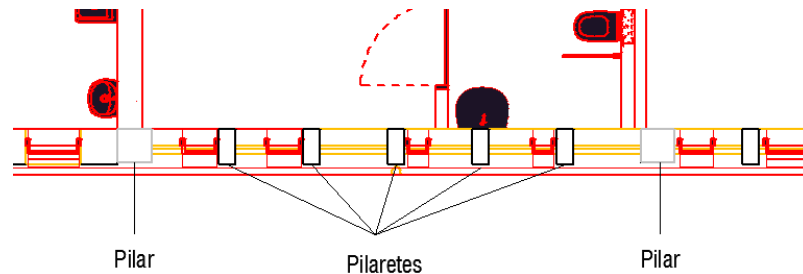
Planta de amarelos e encarnados - Pilaretes de fachada (adaptado de [10])
